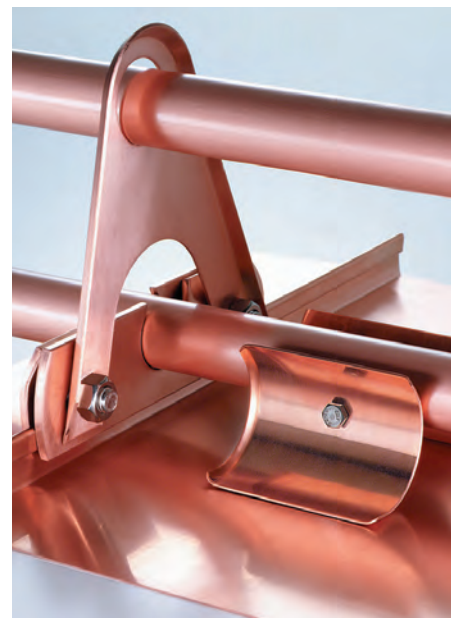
Diese Detailaufnahme zeigt die Befestigung der Rohre mit Klemmlaschen an den Längs-Stehfalzen des Metalldaches.
